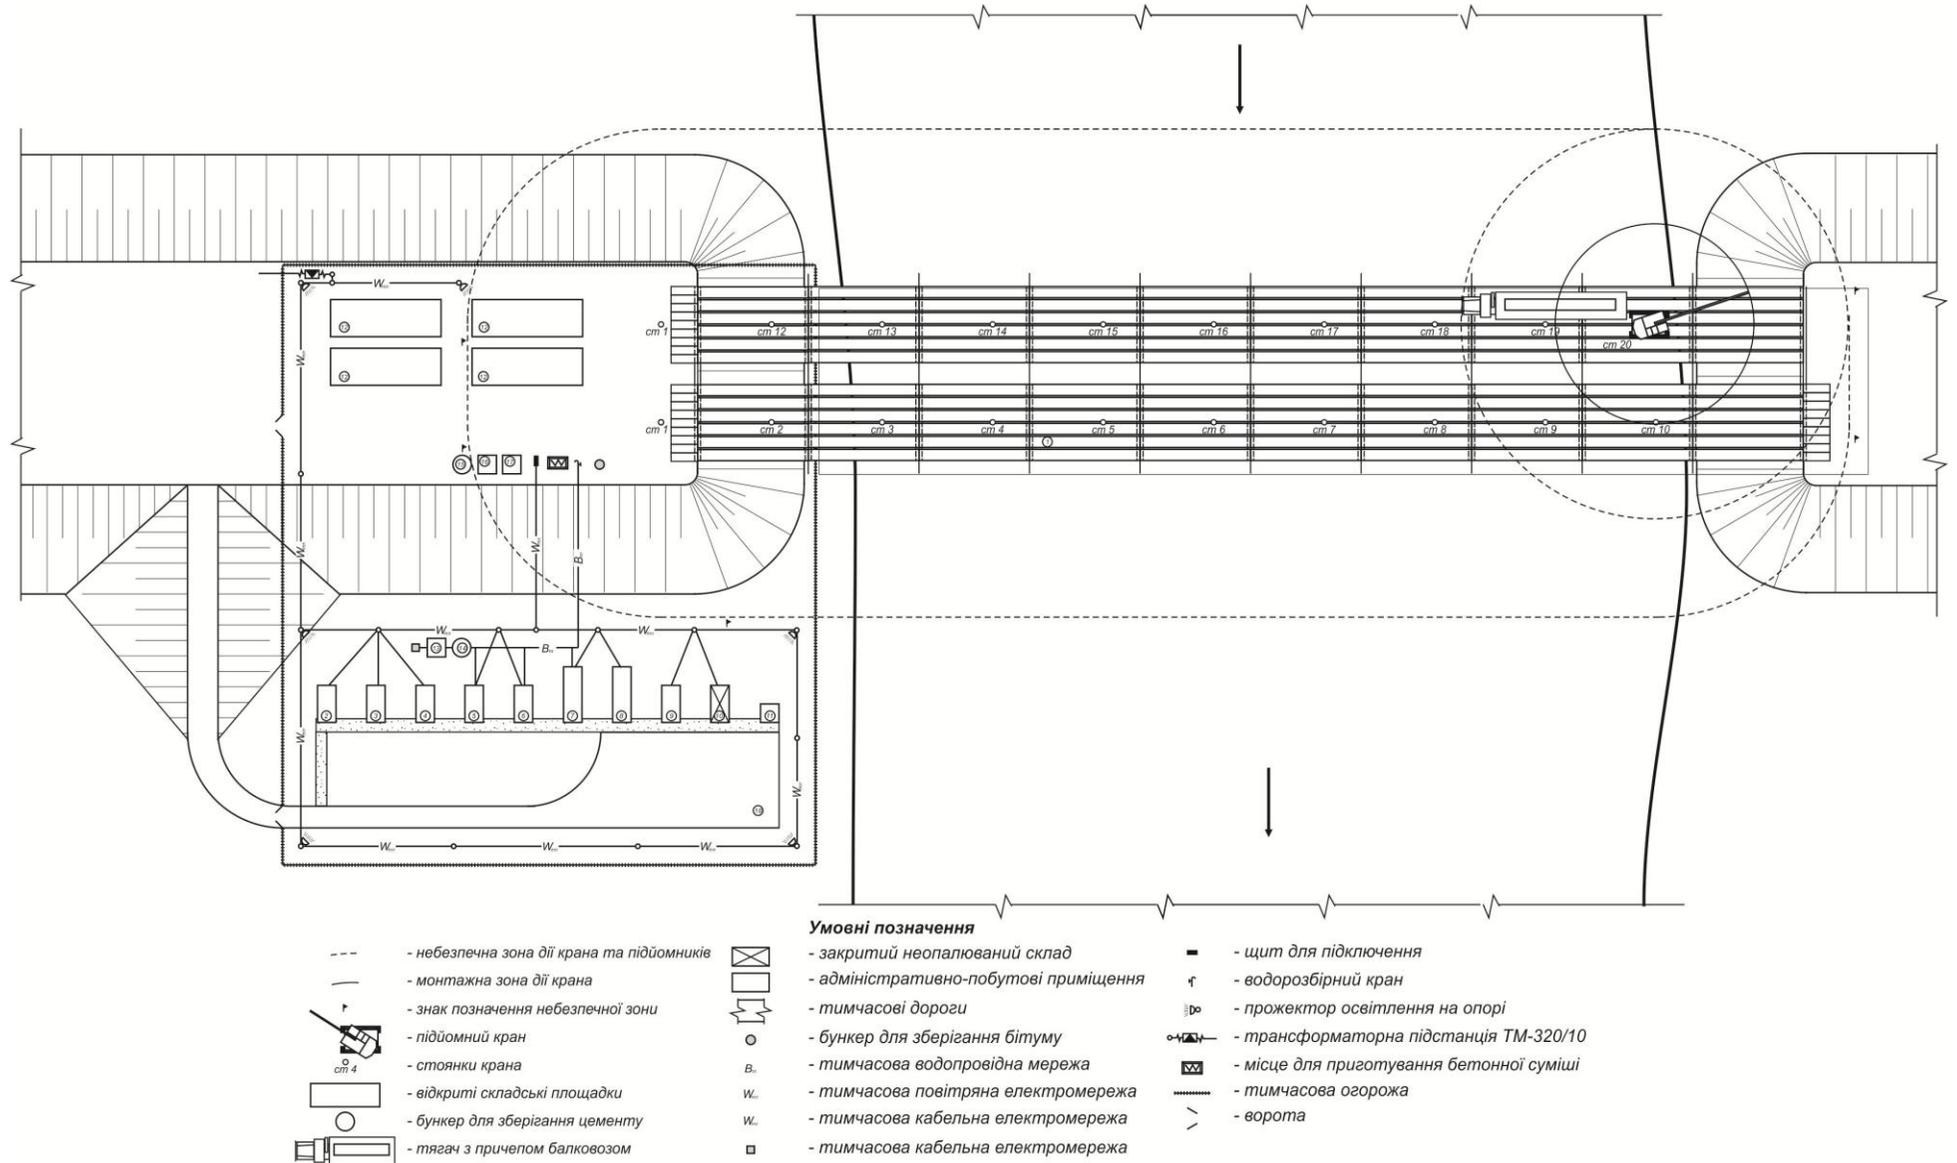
Будівельний генеральний план зведення мостового переходу
